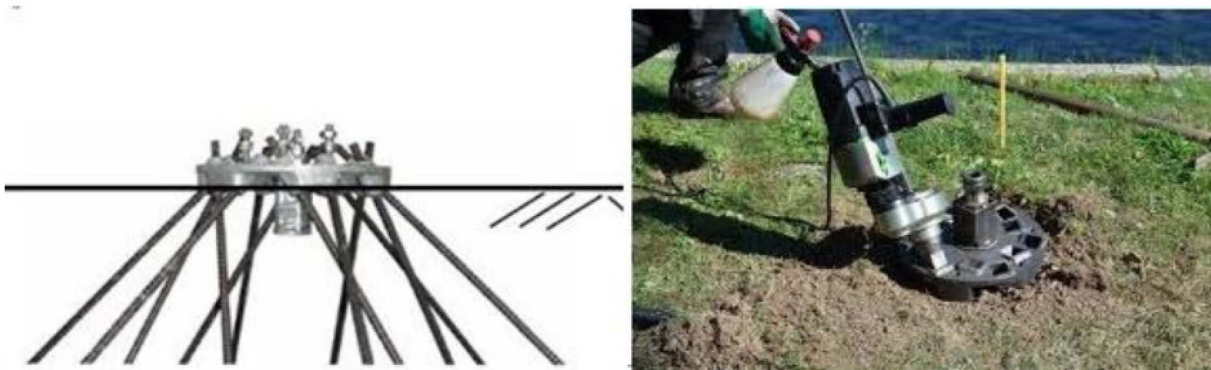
Spinnanker, wird mit einem leichten Handwerkzeug eingedreht
